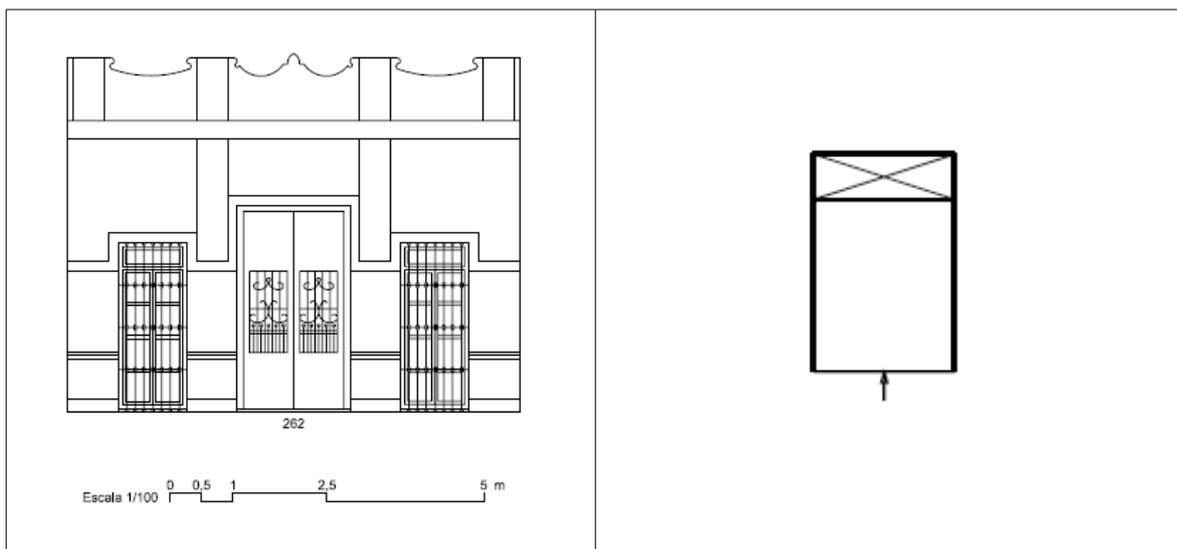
Tipo A12. Ejemplo de fachada y esquema de planta (ficha 214-06)
